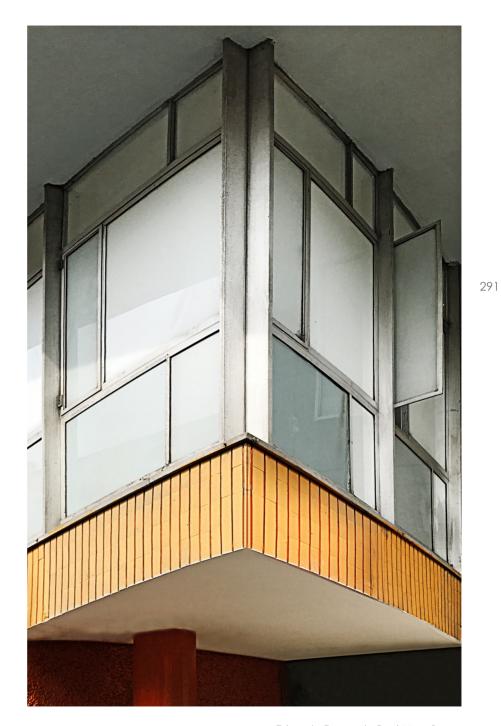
cerramiento translúcido. Edificio Hotel Savoy (2016) Fuente: muro\_arquitectos(2016) Digitalización: Torres, C. (2016)
